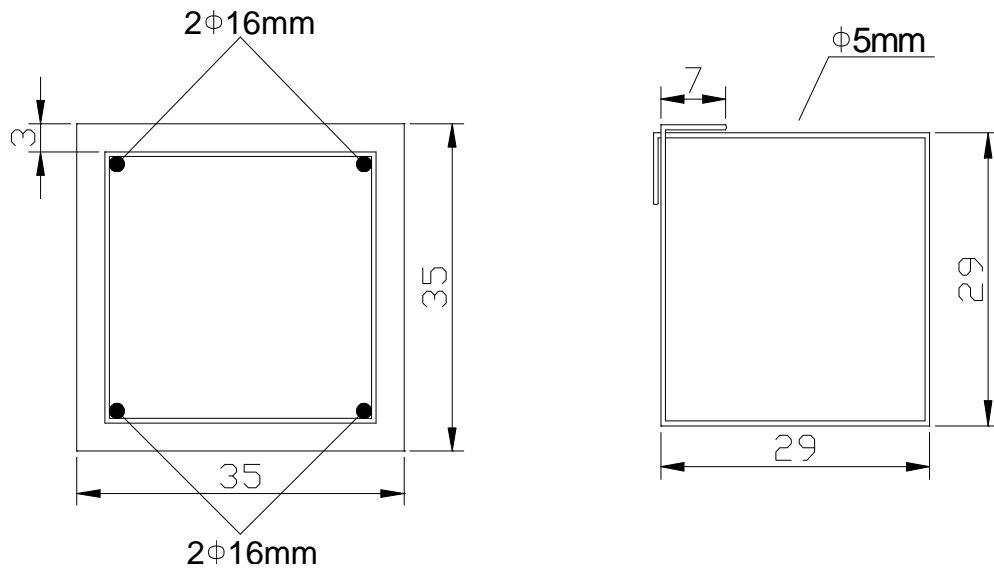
Detalhamento da seção transversal do pilar 6.
